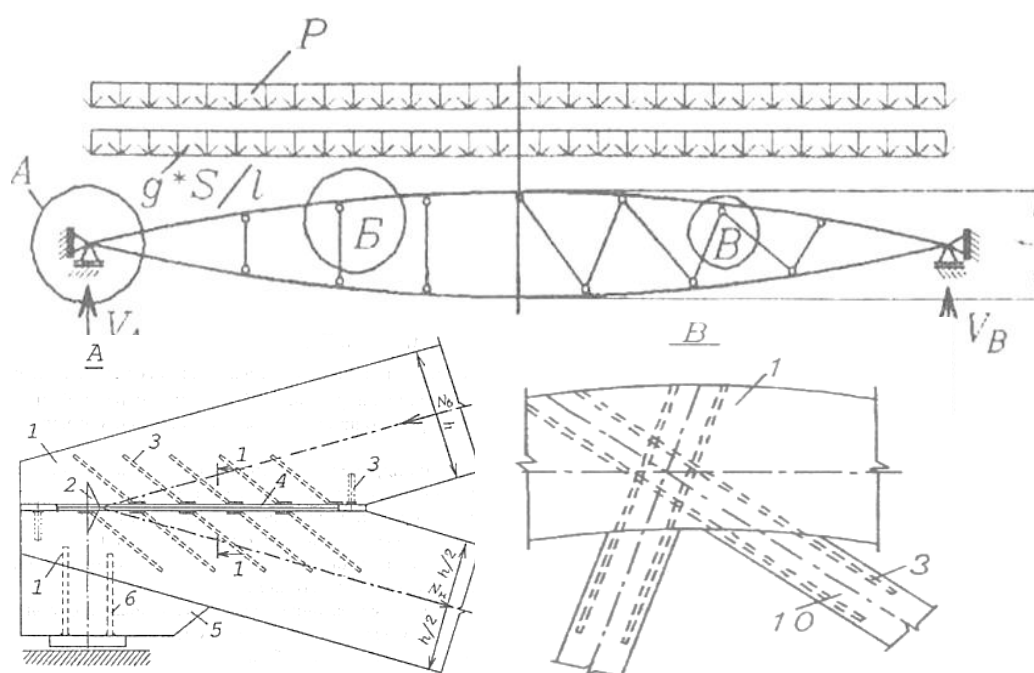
Ферма на клеенных стержнях. а - расчетная схема со стоечной решеткой; б - то же, с раскосной: 1 - пояса фермы; 2 - стальная монтажная пластинка; 3 - клеенные стержни; 4 - анкерные пластины; 5 - опорные клеенные подушки; 6 - клеенные стержни с опорными пластинами; 7 - соединение анкерных пластин сваркой; 8 - то же, болтами; 9 - стальные элементы, привариваемые к стержням; 10 - раскосы.
